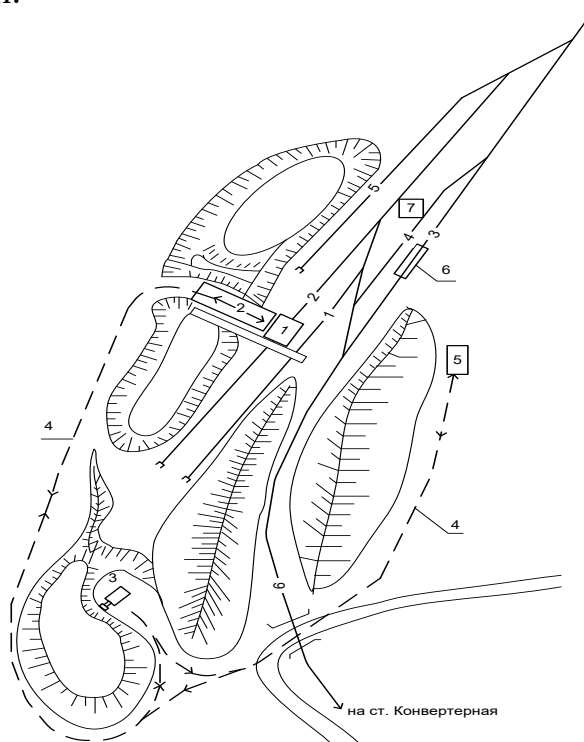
Схема розташування споруд і пристроїв ділянки ЦПМШ:
